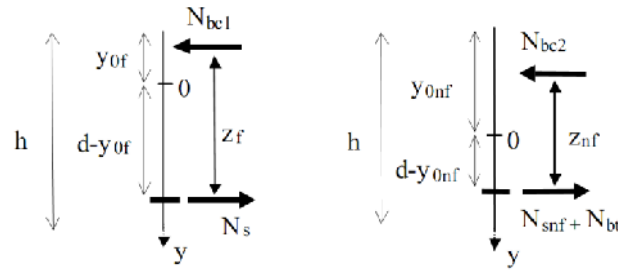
Efforts internes dans des sections de poutres fissurée et non fissurée.
